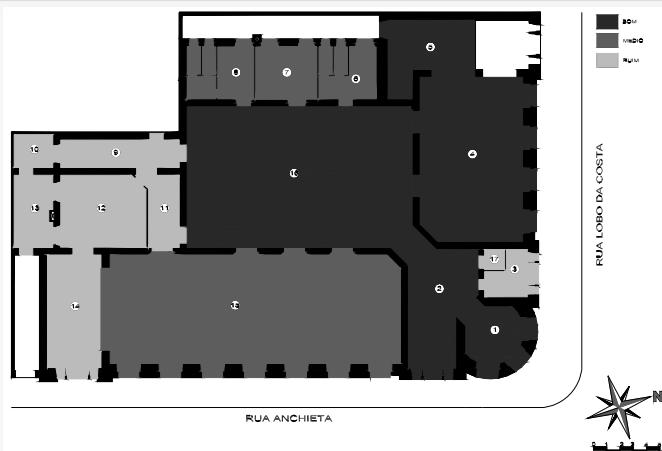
Planta Baixa do 1º Pav. – Estado de Conservação. Desenho: Cristiane Müller.
